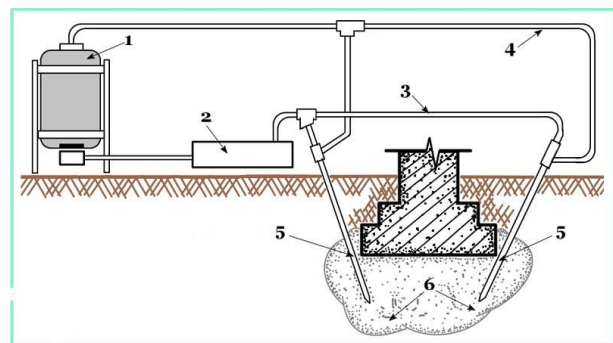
Підсилення фундаментів закріпленням слабого шару ґрунту:
